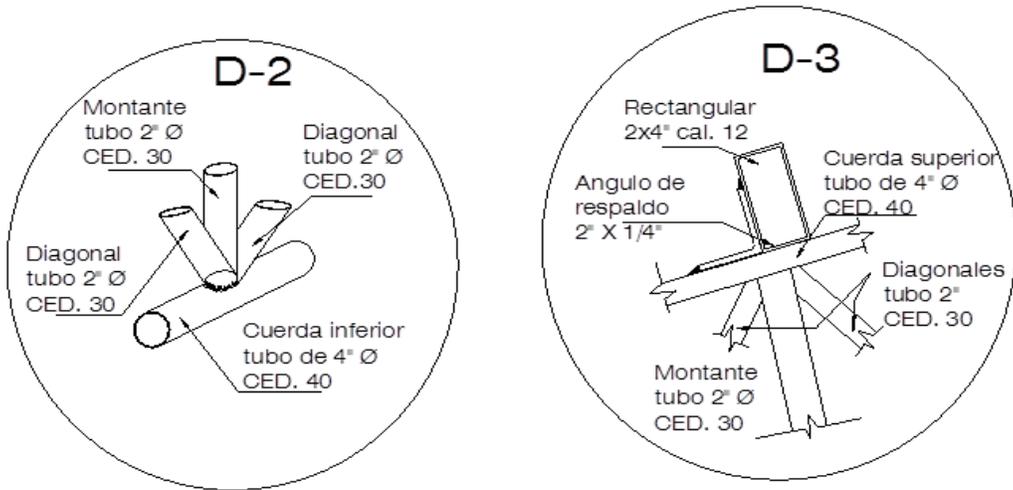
Detalles de conexiones y soldaduras para la armadura.
